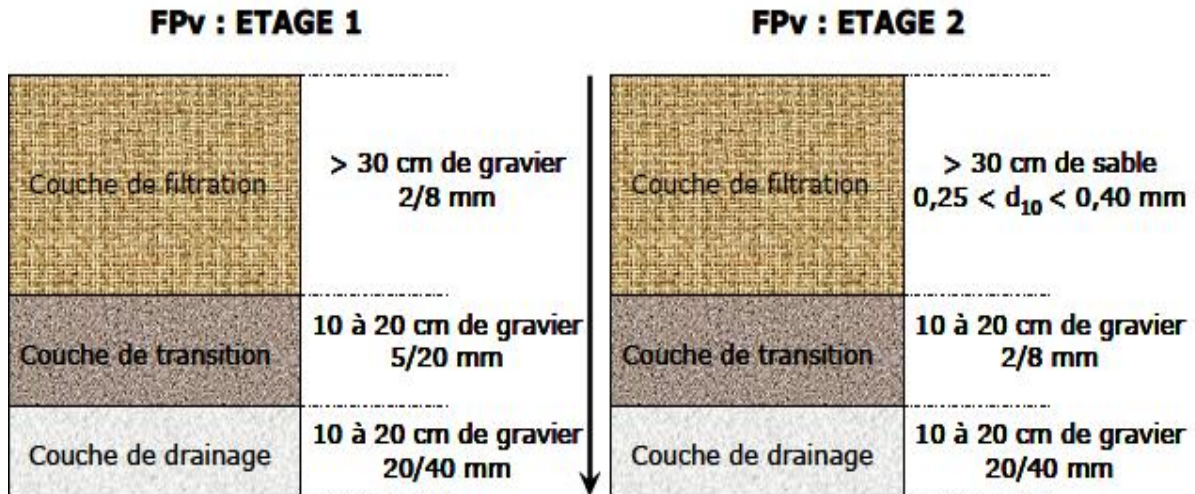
coupe transversale d'un filtre planté à écoulement vertical.
